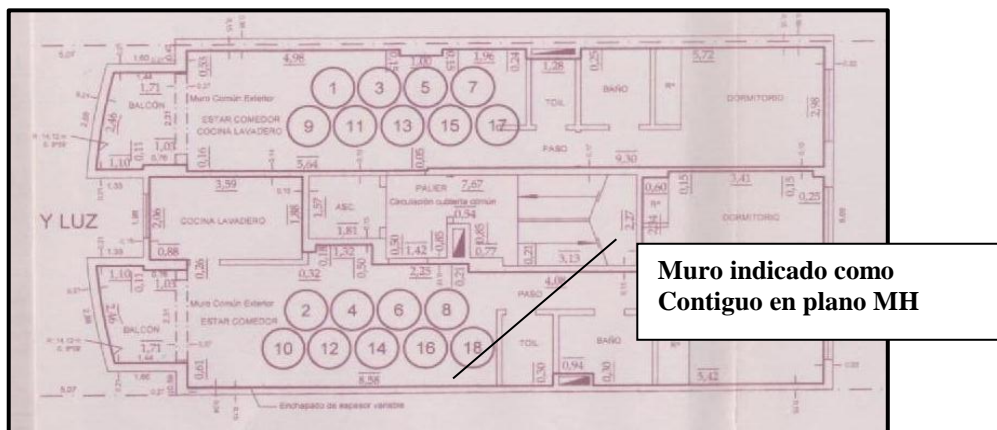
Plano MH -XX- 2006 Planta 1° a 9°
